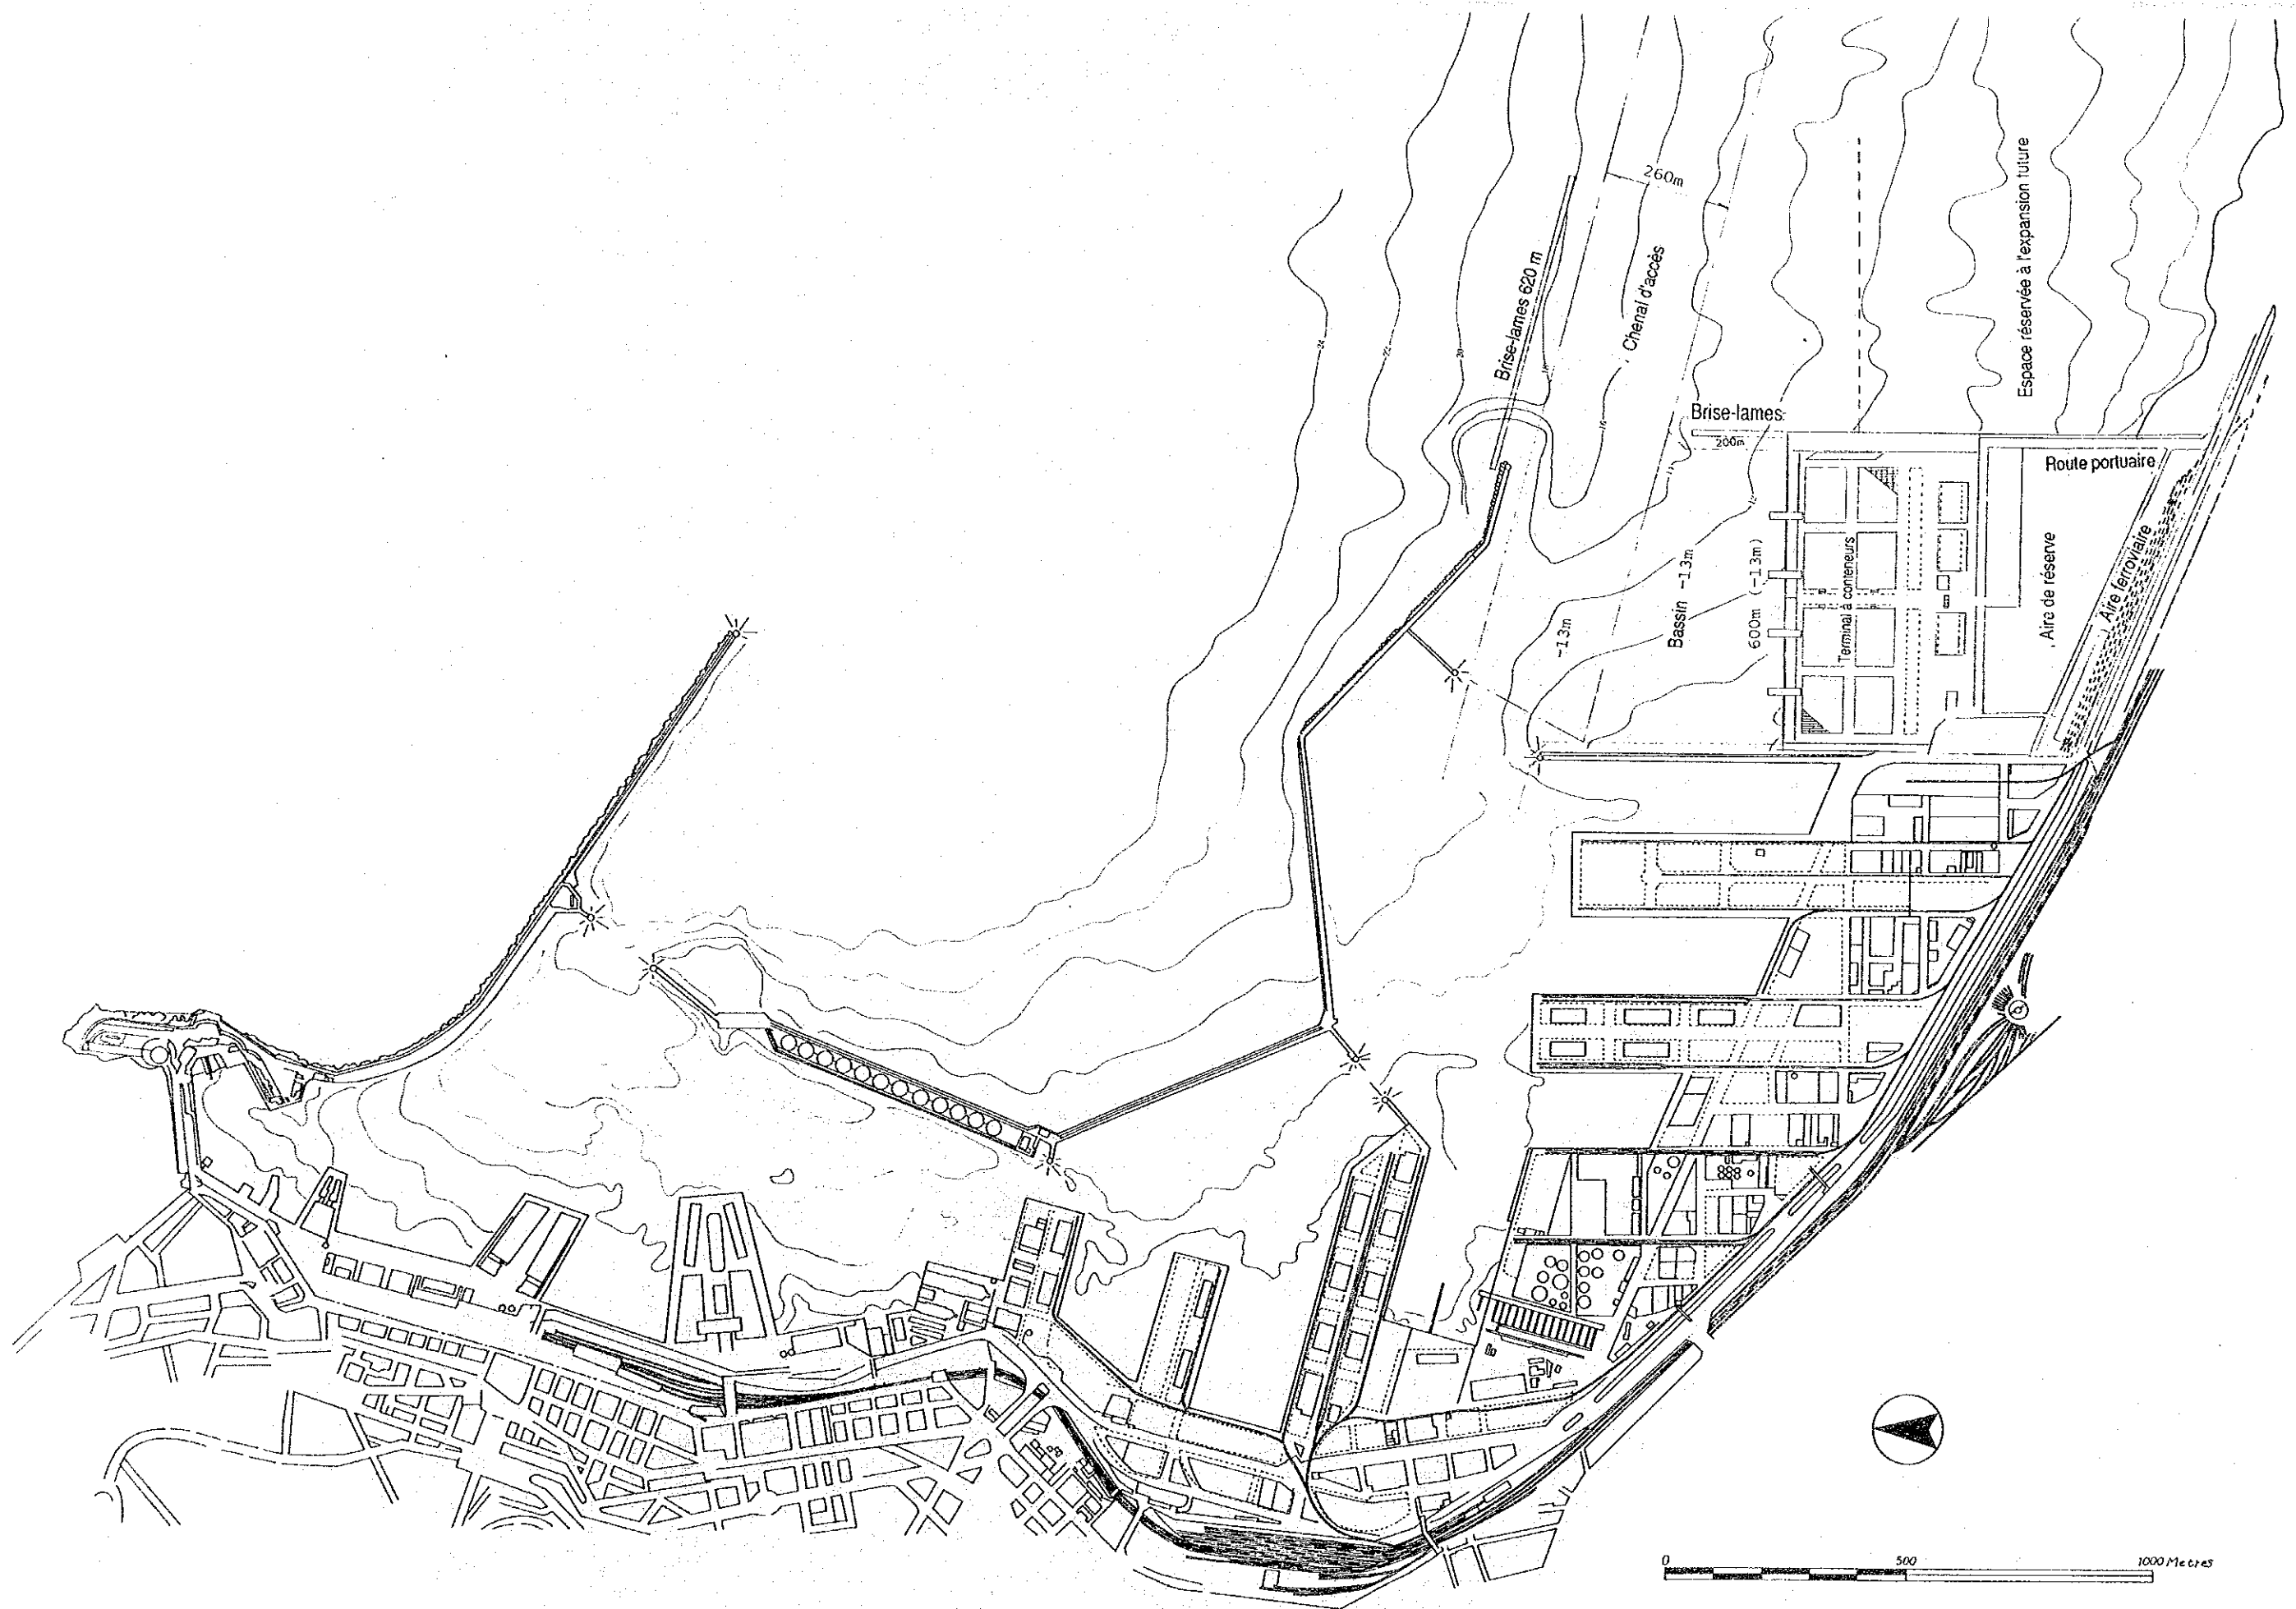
Plan de développement de substitution pour le terminal-2 (cas 1)
